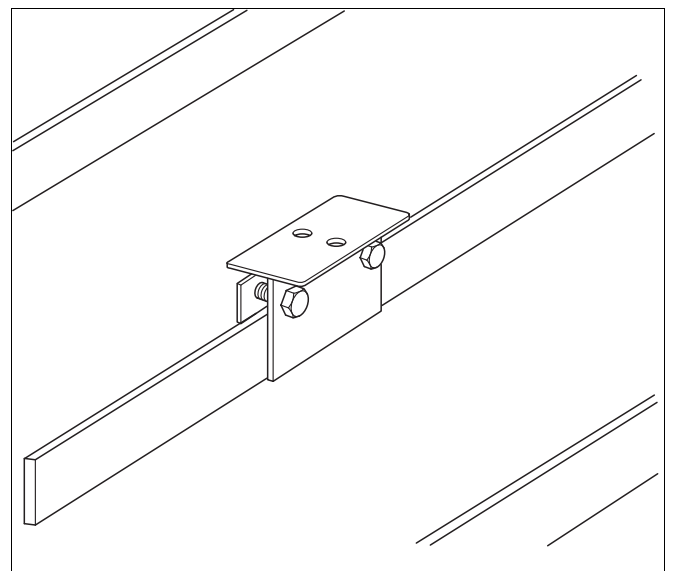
Beispiel für Halterung auf dem Blechdach (bauseits)
